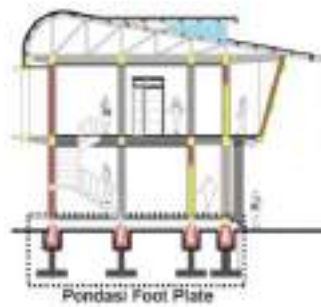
57 konsep bentuk dan tampilan bangunan sewa sepeda
